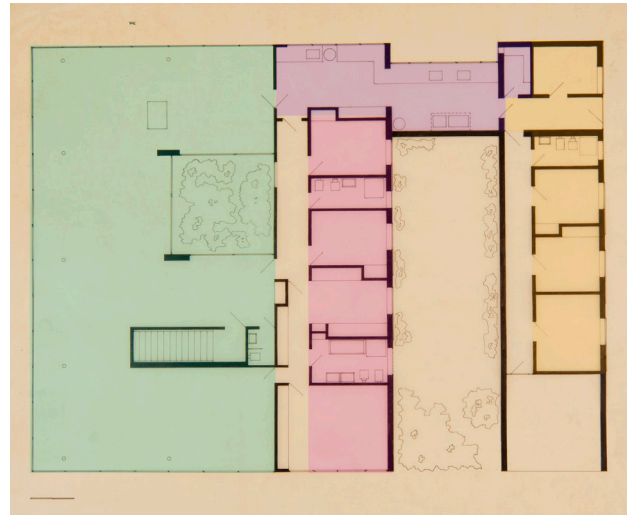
Casa de Vidrio. Planta intervenida con identificación de zonas. Elaboración propia.
